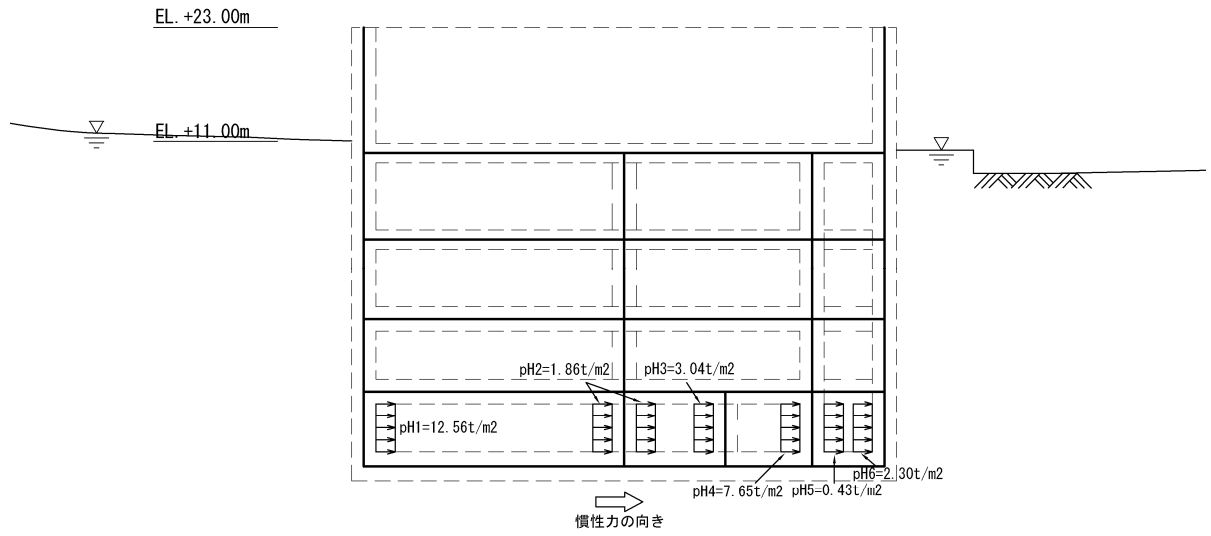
(3) 水平動による動水圧図 (東西方向断面)
